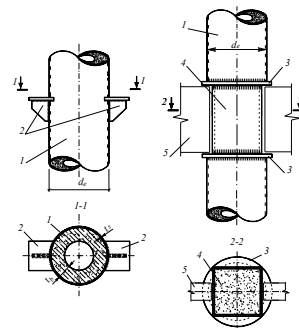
Узлы опирания балок по высоте трубобетонной колонны с устройством консолей а, с квадратной вставкой б: 1 - стержень колонны; 2 - консоль; 3 - опорный лист; 4 - прямоугольная соединительная трубобетонная вставка; 5 - балка перекрытия
